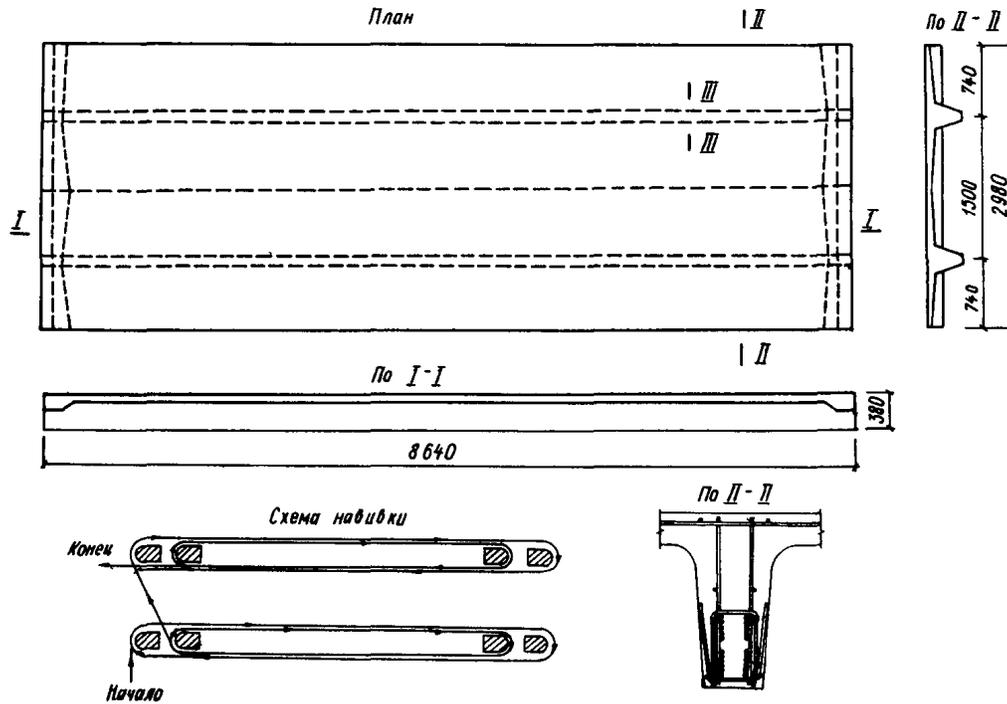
Схема навивки арматурного каркаса плиты 2Т(87-30-16)
